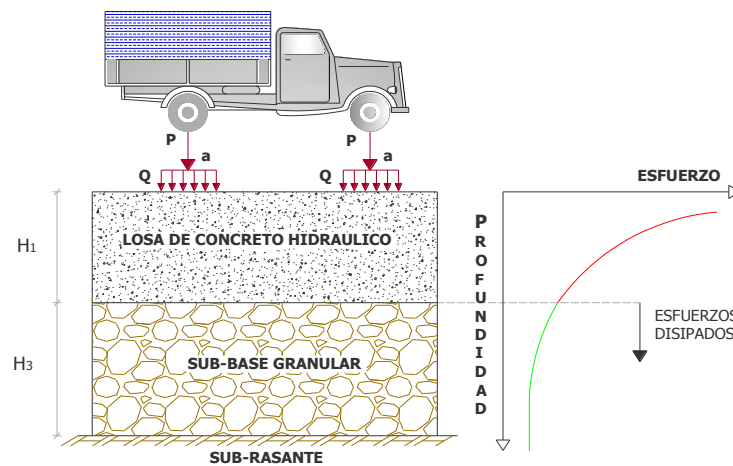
Mecanismo de distribución de cargas en pavimentos rígidos
